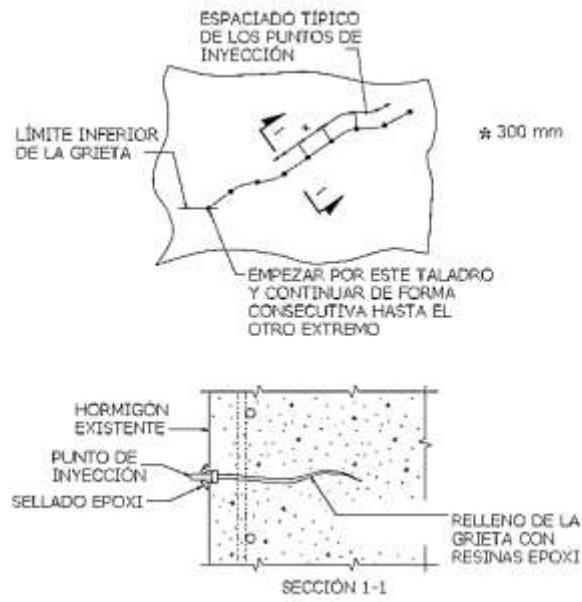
Detalle de grieta en el revestimiento de un túnel
